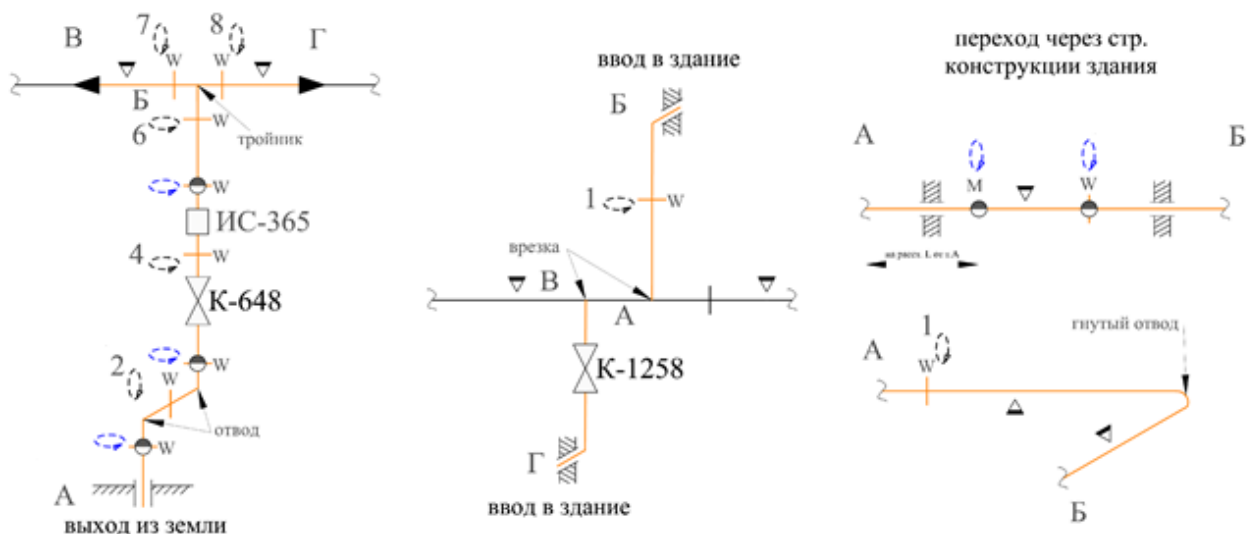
Типовые схемы проведения ультразвуковой дефектоскопии основного металла трубы и сварных соединений надземных газопроводов
